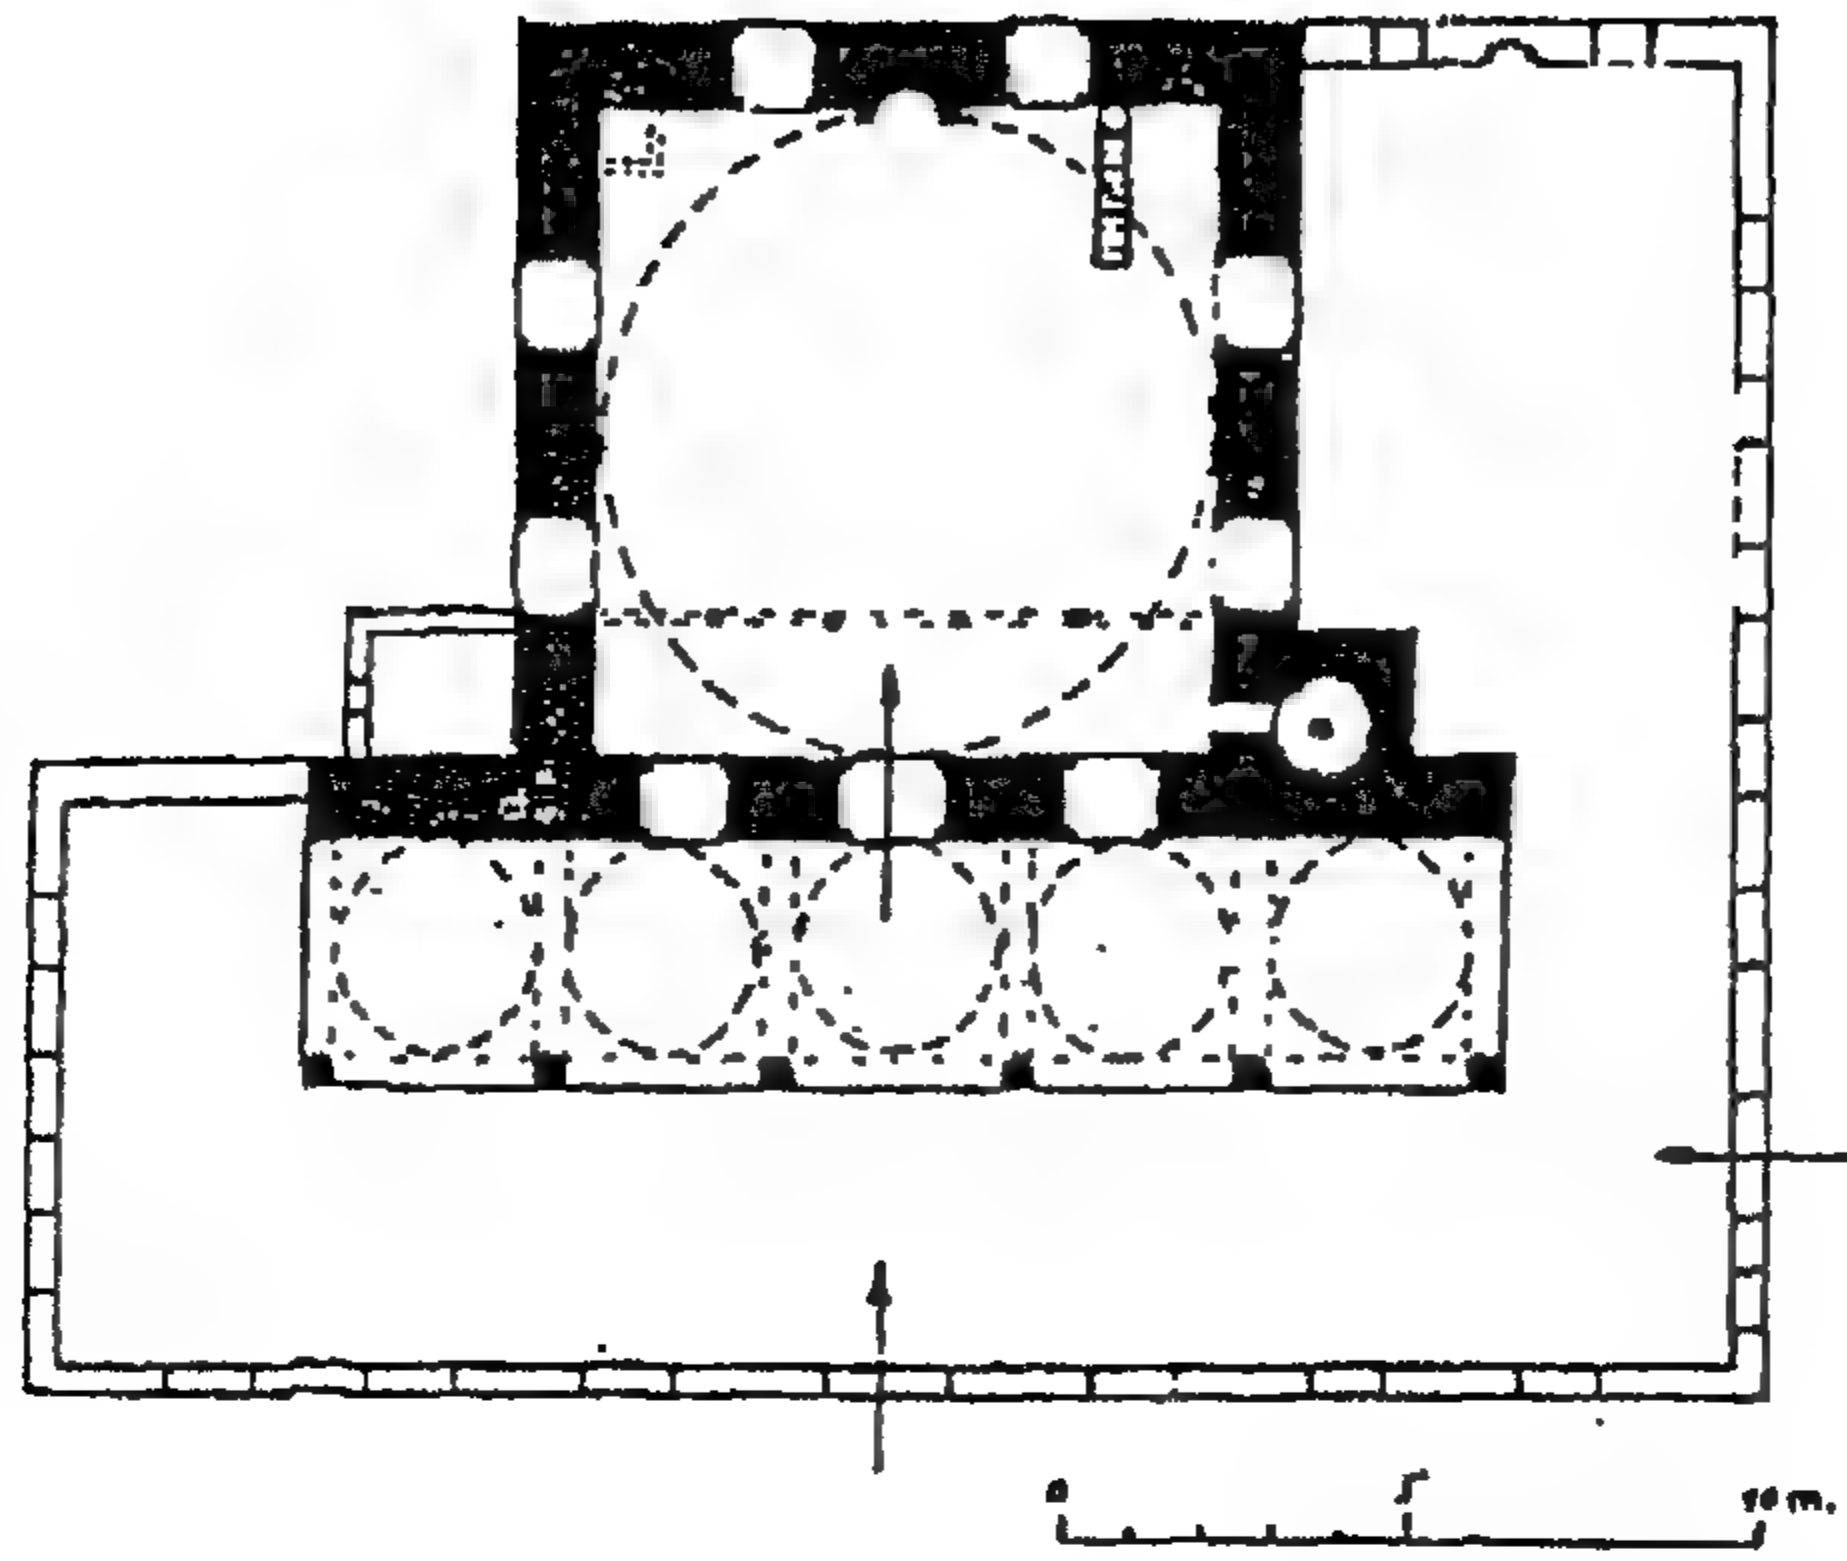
مسقط أفقي لمسجد الفاتح في كستنديل (عن : ايفردي) .
